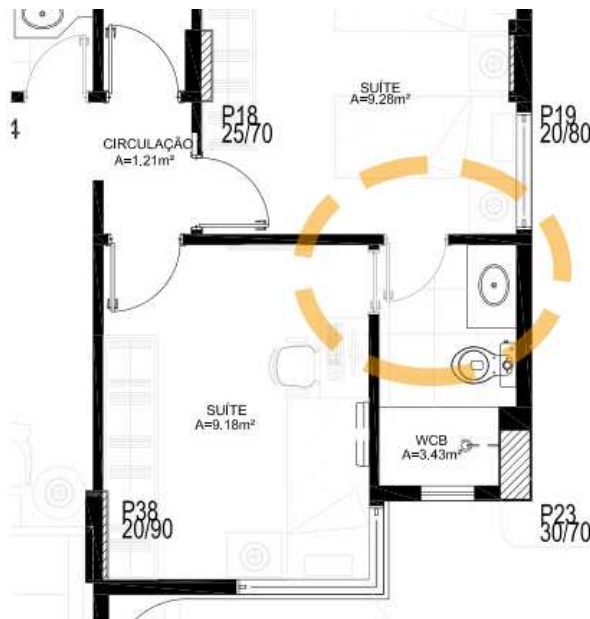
Planta baixa com detalhe do banheiro reversível da terminação 02
